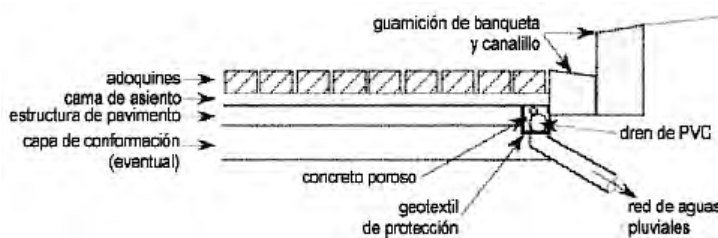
ZONAS LATERALES – Drenaje de la estructura del pavimento y de la cama de asiento.
